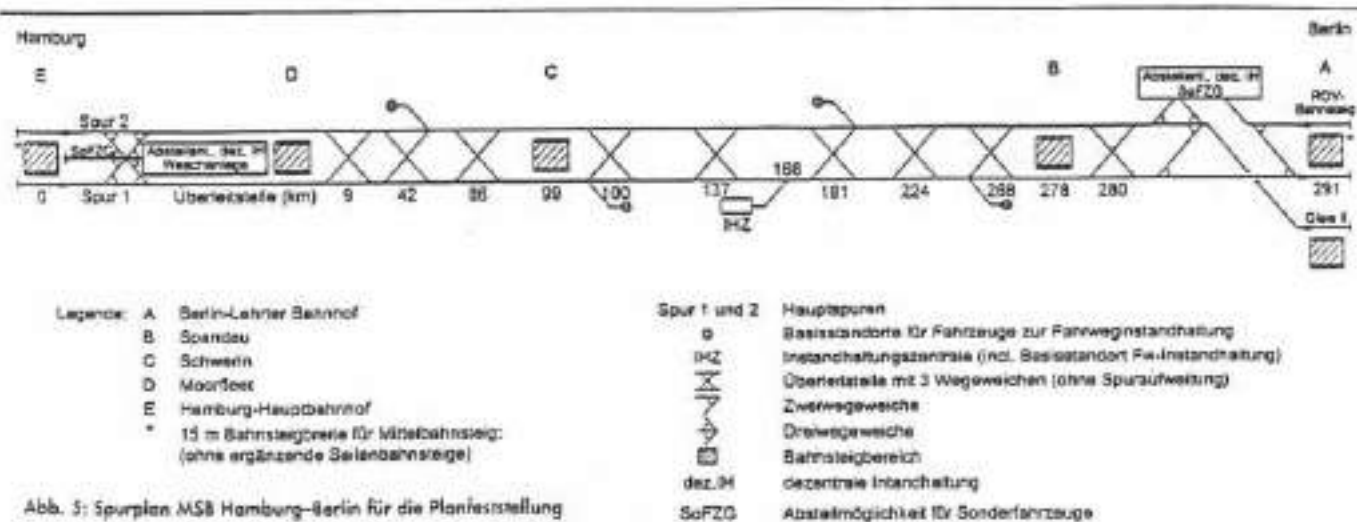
Spurplan MSB Hamburg-Berlin für die Planfeststellung
